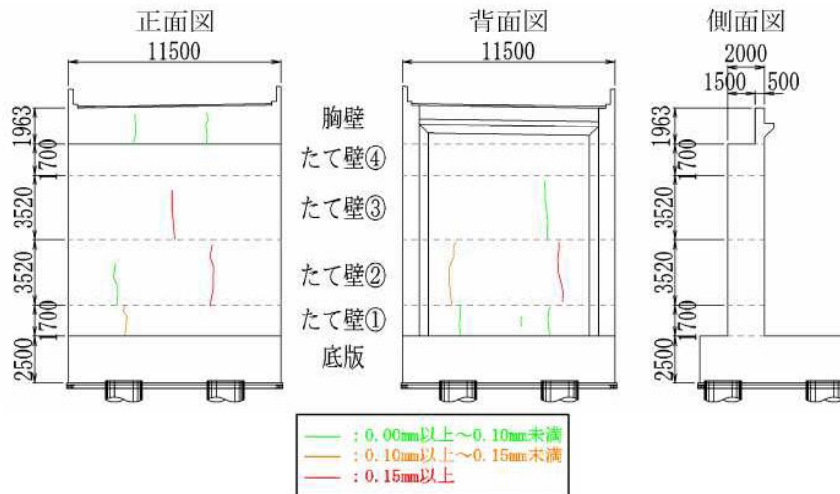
橋台たて壁のひび割れ状況(普通ポルトランド)
